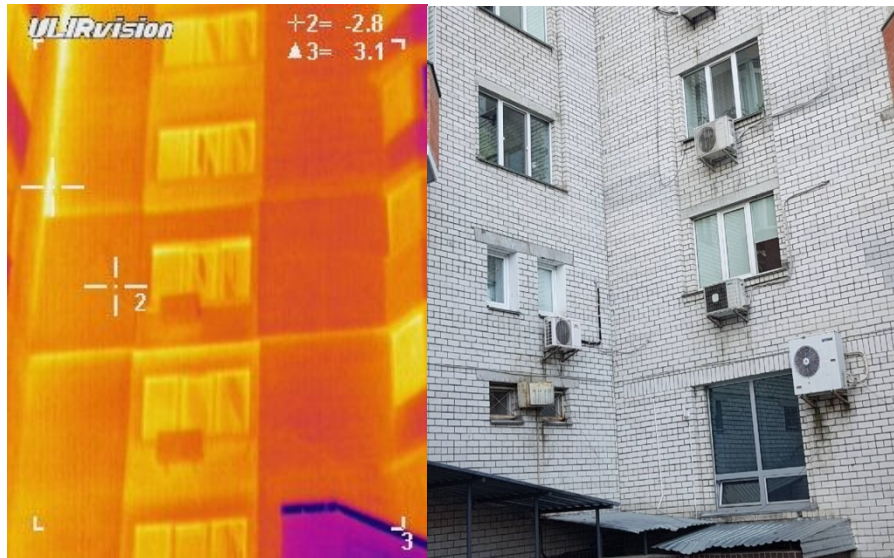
Тепловізійна зйомка фасаду будинку
